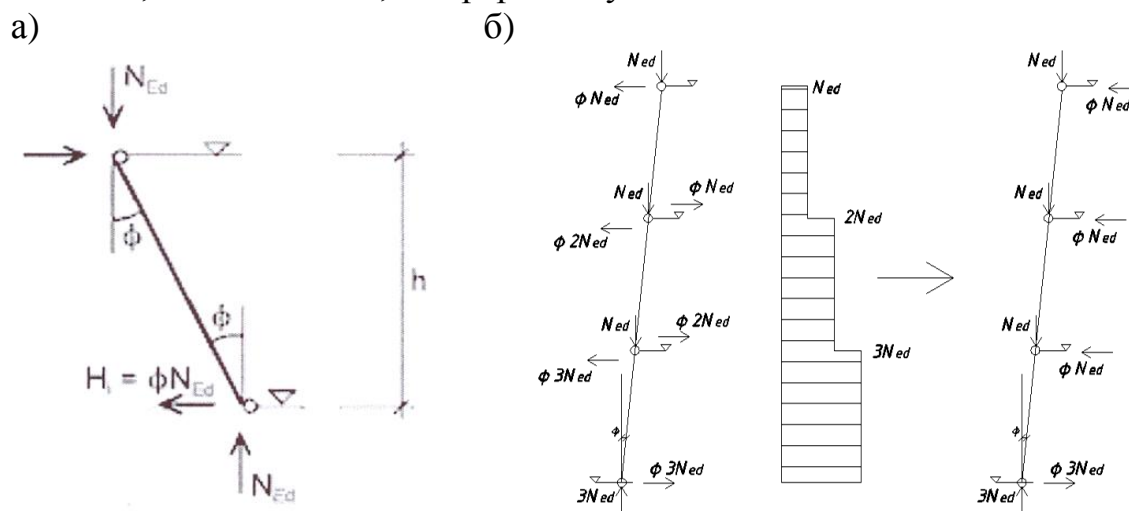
а) Схема для определения поперечной силы по нормам [5];
